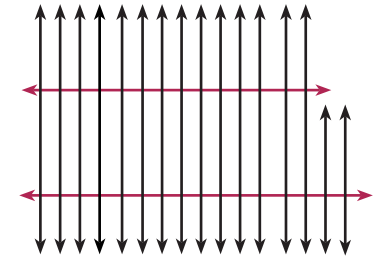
/ Análisis de Referentes Hospital Paramétrico del Puyo / Plataforma Arquitectura Sistema Constructivo de Viga-columna-Paneleria
